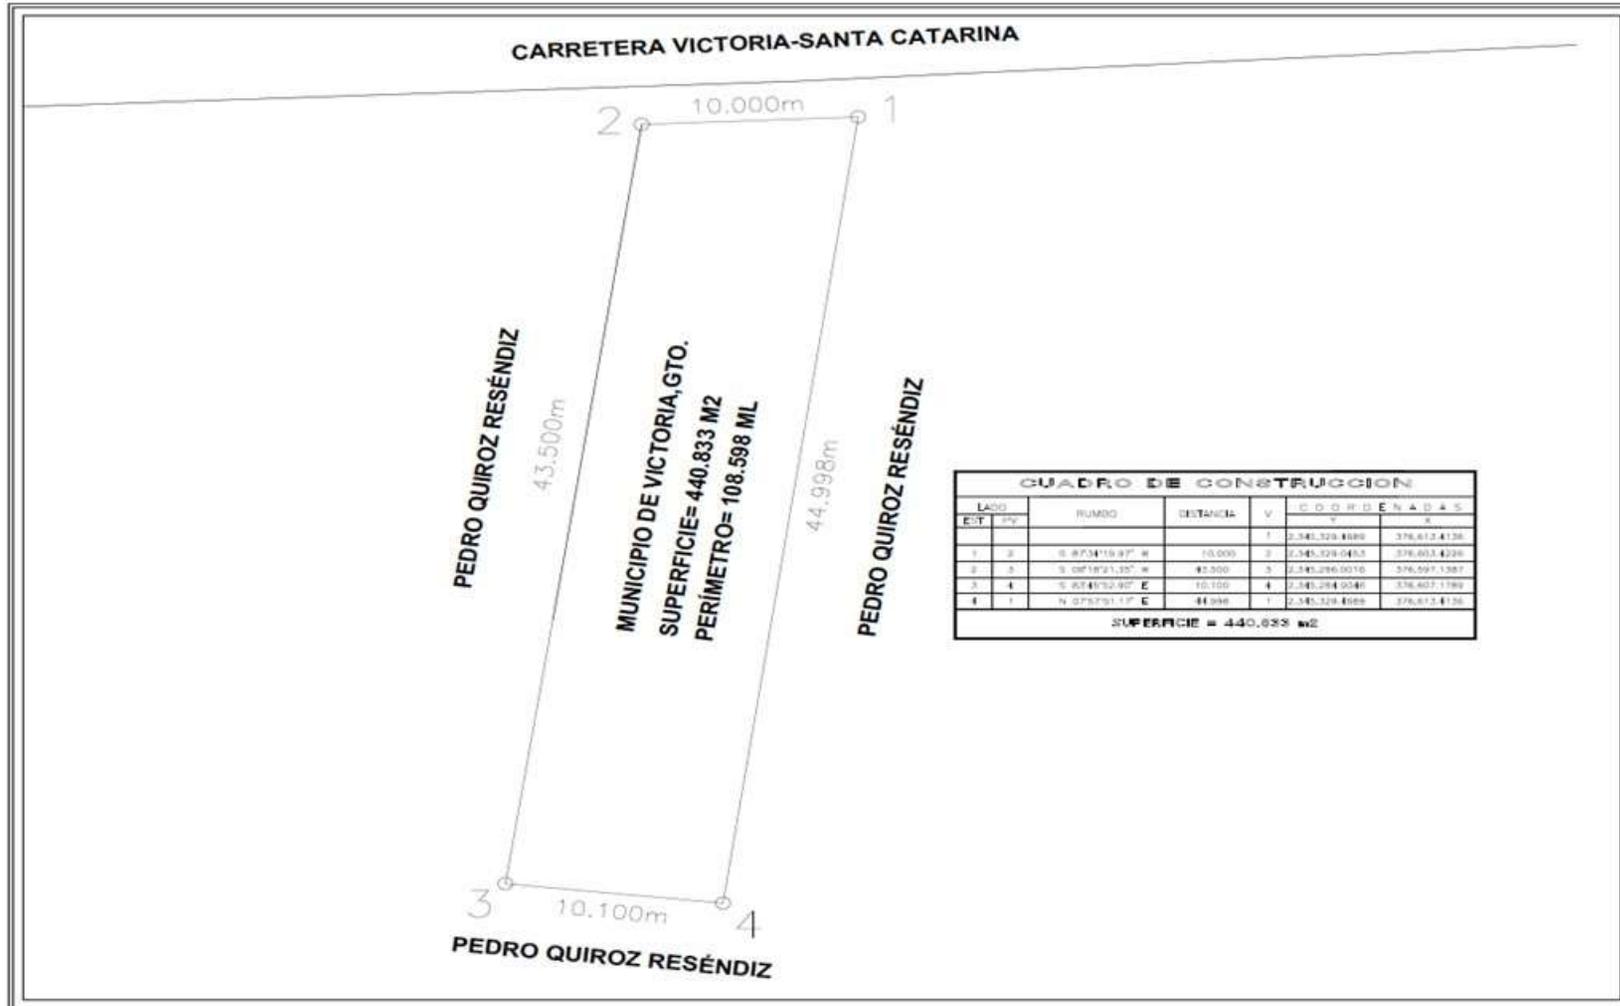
Croquis del terreno donde se construirá la planta potabilizadora (440.83 m²)
